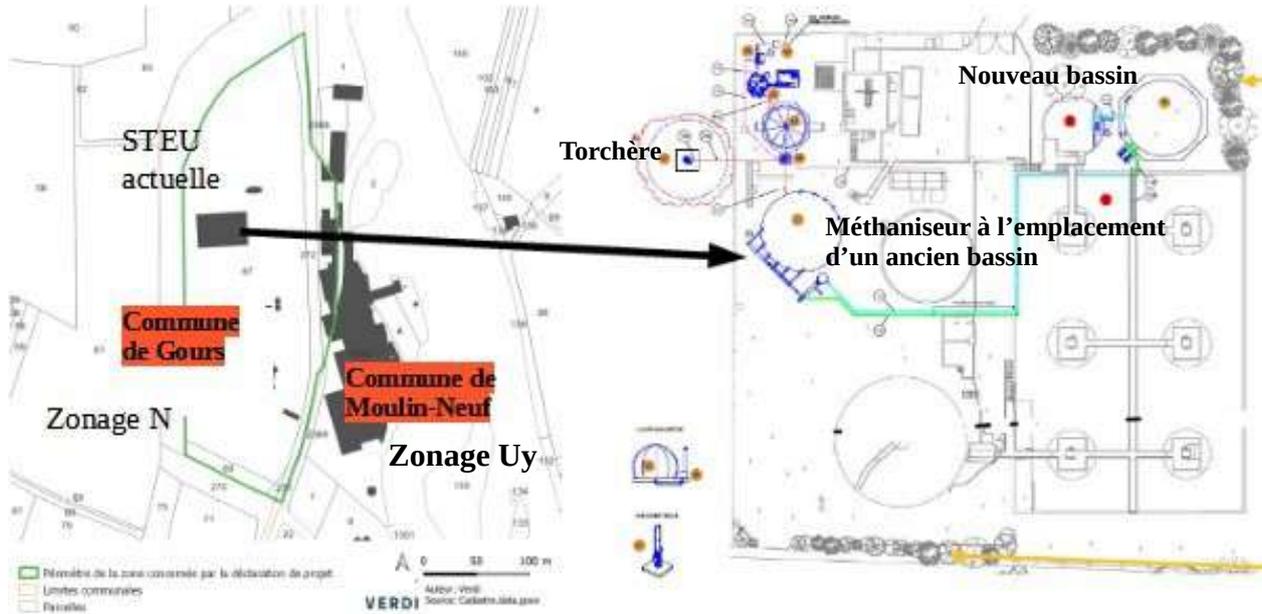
Extrait du plan cadastral et plan de masse du projet retenu (Source : notice explicative, pages 25 et 176)
